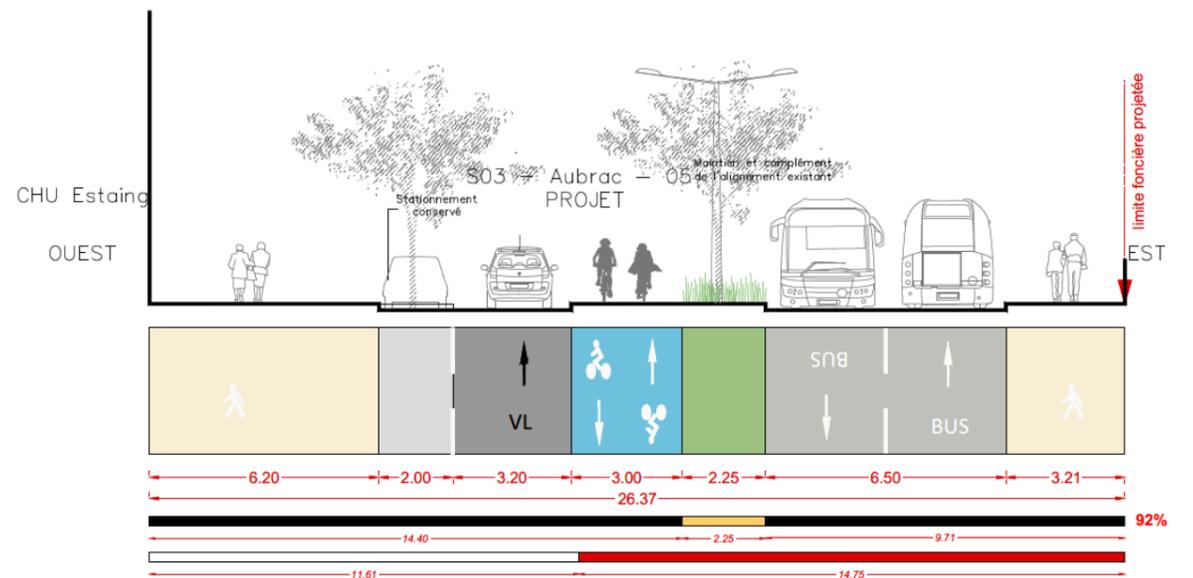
Profil d'insertion du projet de BHNS sur la rue Aubrac au droit du CHU Estaing
